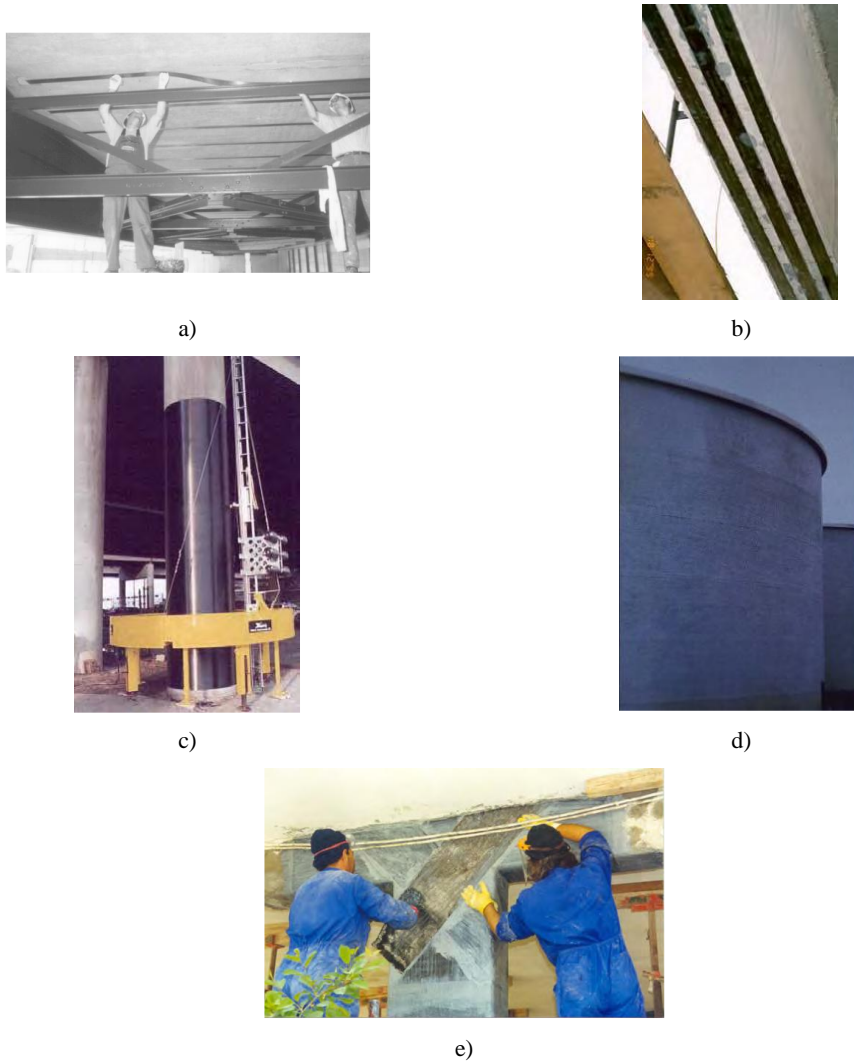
a) reforço à flexão de uma laje; b) reforço à flexão de uma viga; c) reforço ao corte e confinamento de um pilar de betão; d) confinamento de um tanque de betão; e) reforço ao corte de uma zona de nó viga/pilar (fib 2001)
